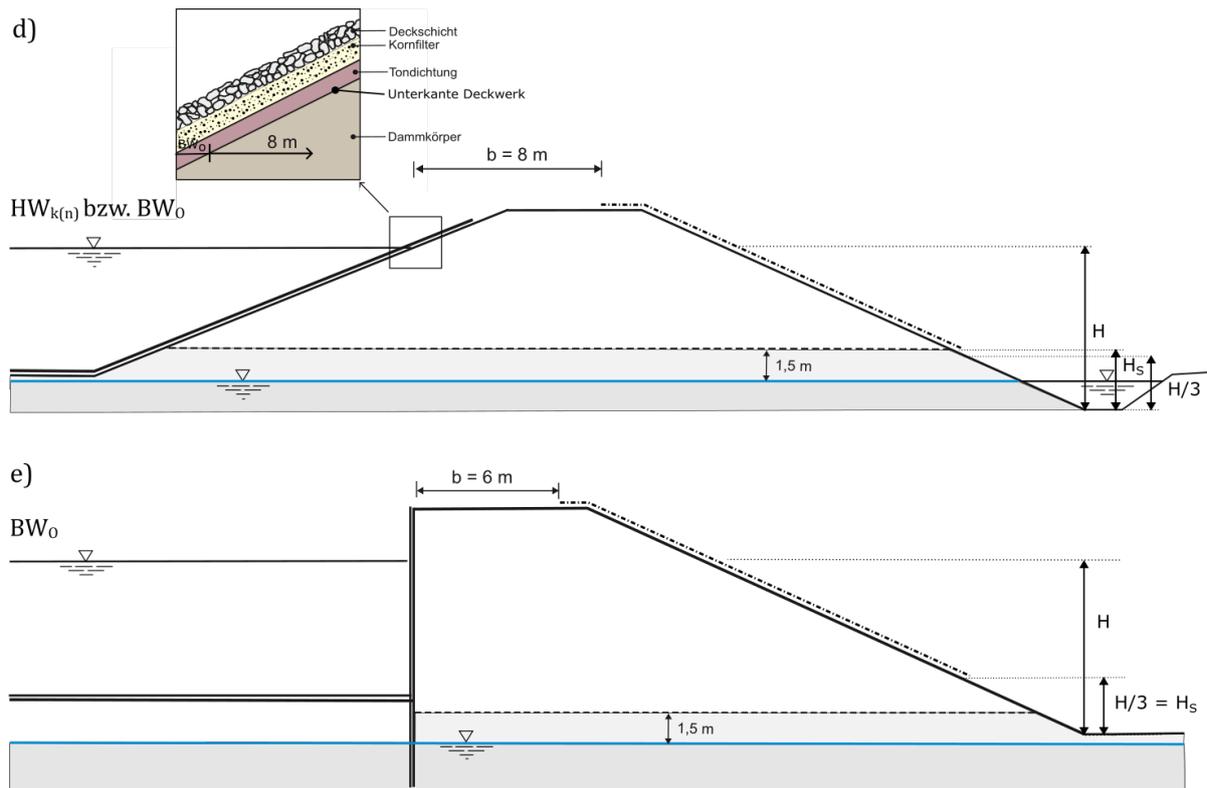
Ermittlung des Dammbereichs mit zulässigem Gehölzbewuchs (strichpunktiert) bei Dämmen mit dichtem Gewässerbett und Oberflächenichtung auf dem Schrägufer (d) und nicht überströmter Uferwand (e)
